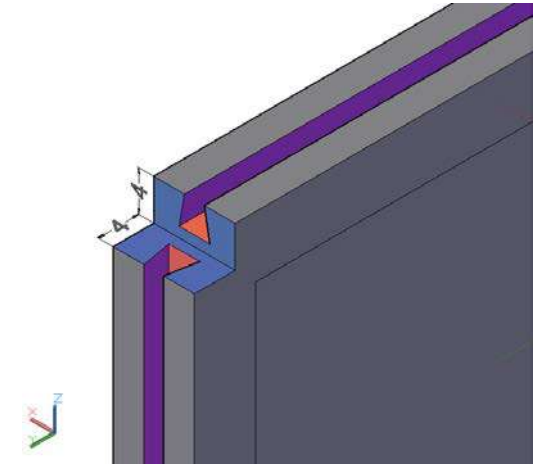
Corte en esquinas de piezas rectangular (cotas en cm).
